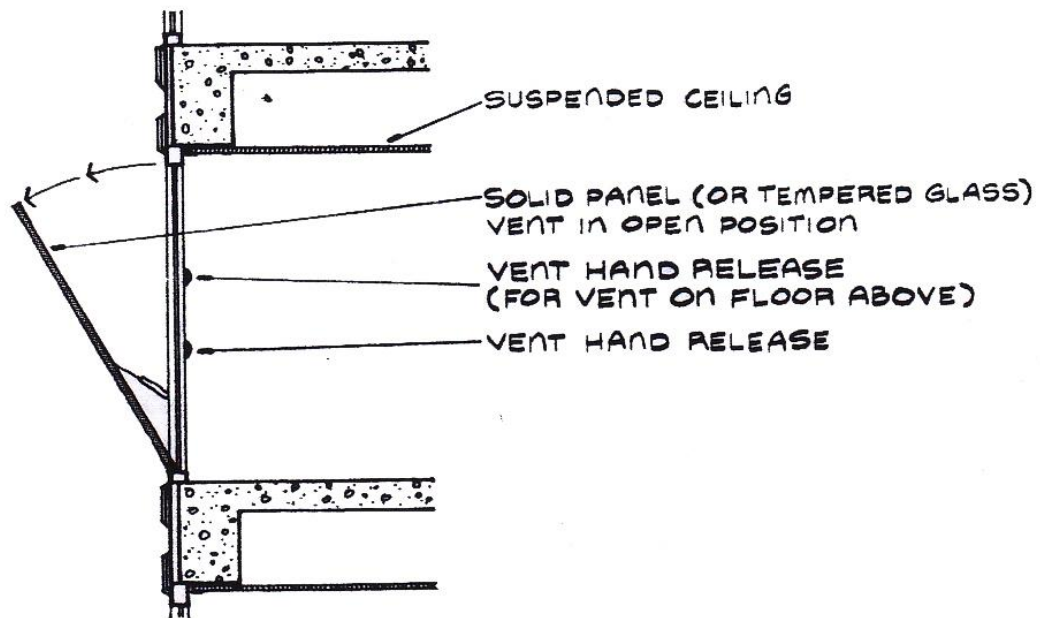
Bangunan dengan sistem pengendalian asap
